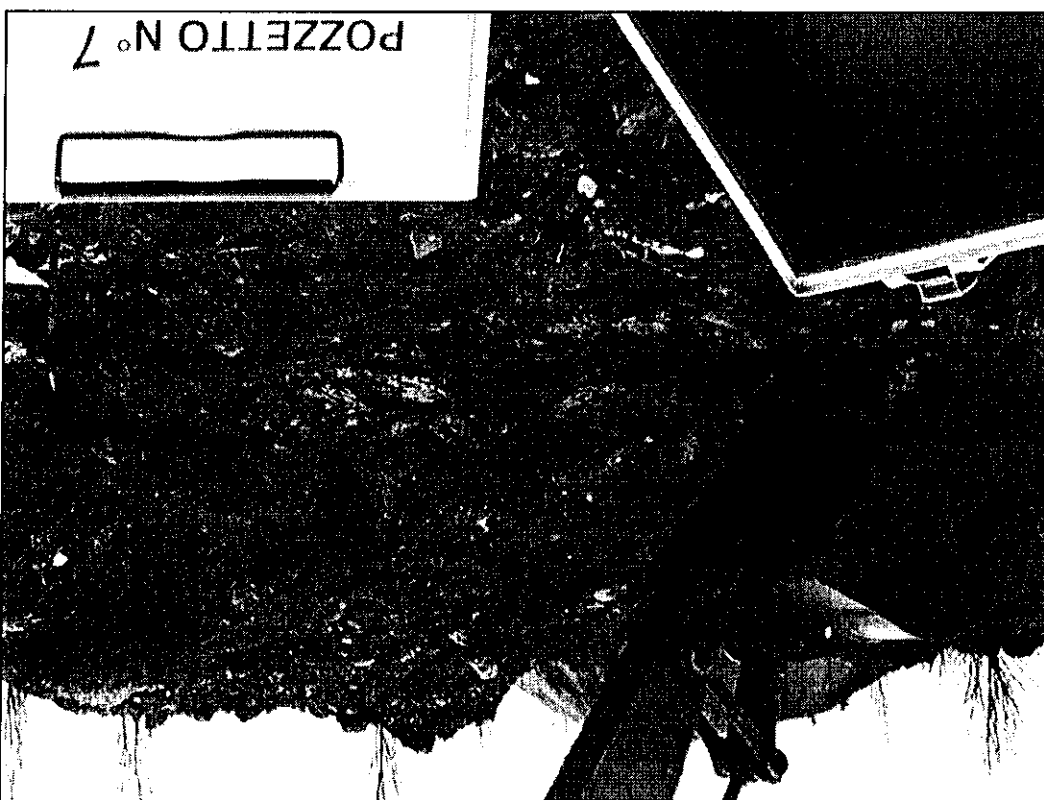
Pozzetto n° 7. Profondità -1,20 m dal p.c.
